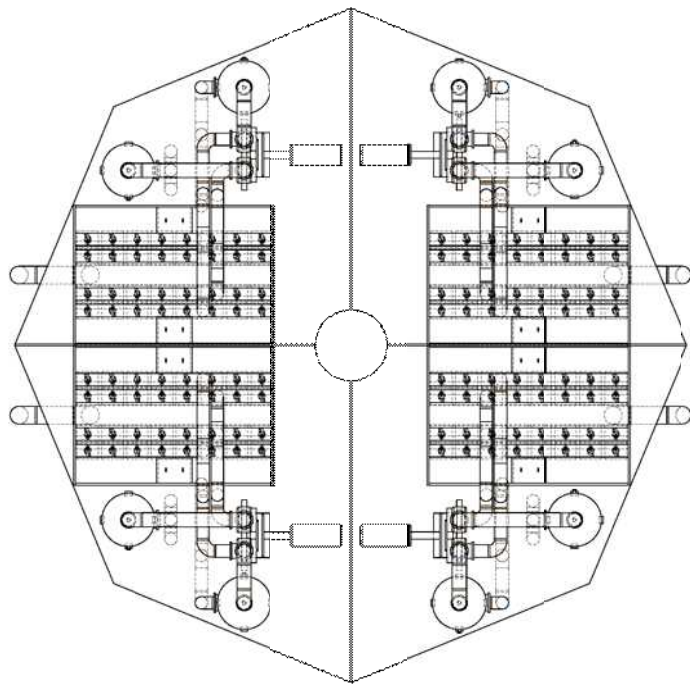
(Cont'd) 概略配置图 (10MW 2 階部 平面图・立面图)
